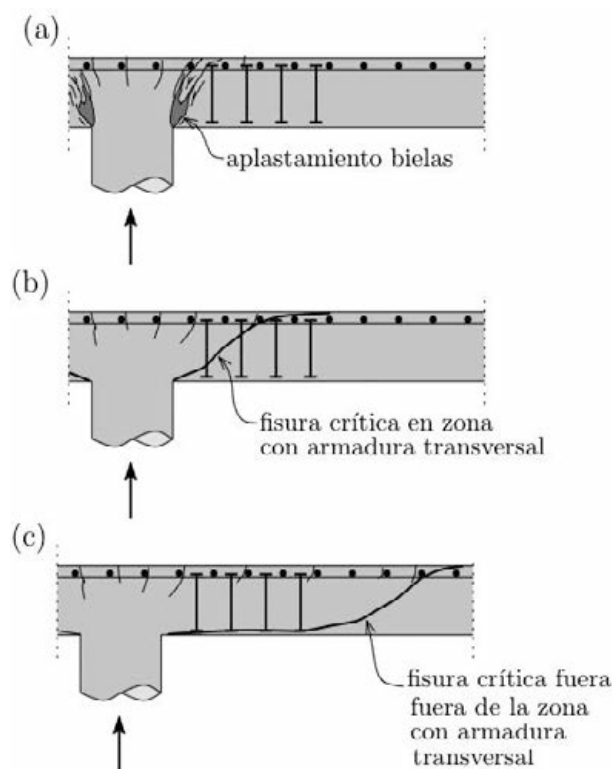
Modos de rotura en losas con armadura transversal: (a) aplastamiento de bielas; (b) punzonamiento con localización de deformaciones en la zona con armadura transversal; y (c) punzonamiento fuera de la zona con armadura transversal
